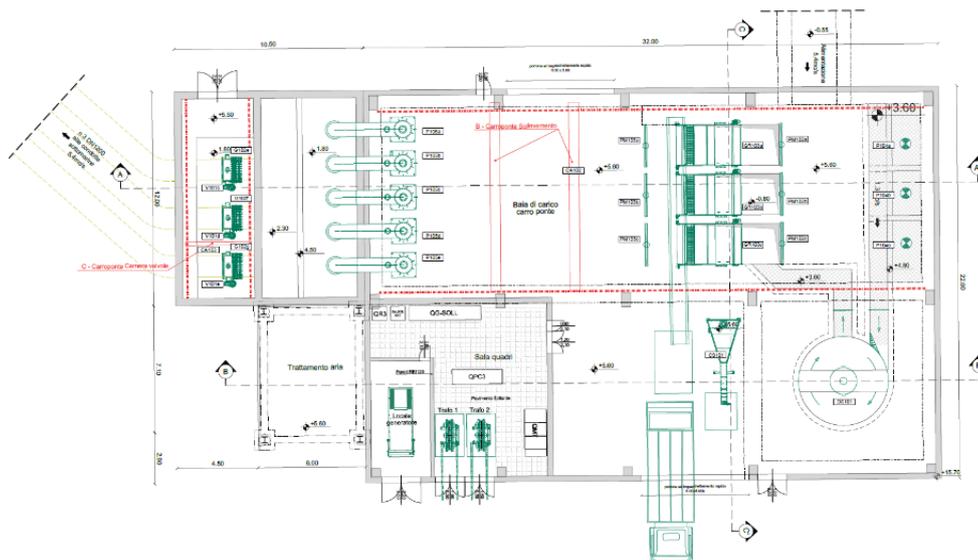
Nuovo impianto di sollevamento a mare e pretrattamento – Planimetria
